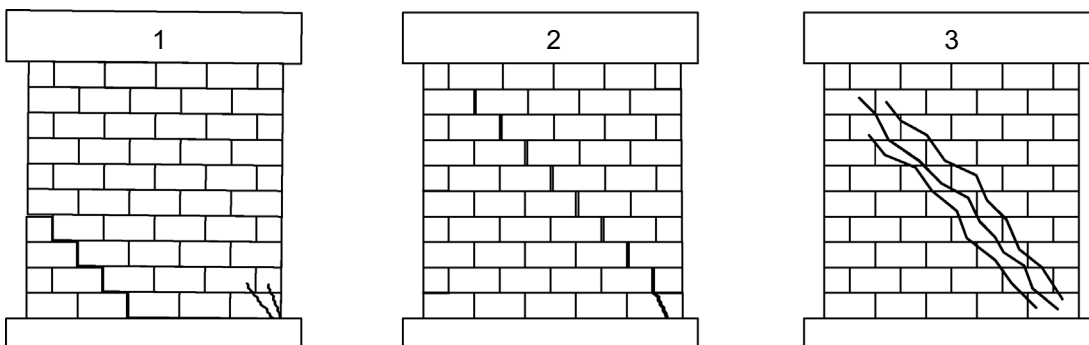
Grenztragmechanismen von unbewehrten Mauerwerkswänden
